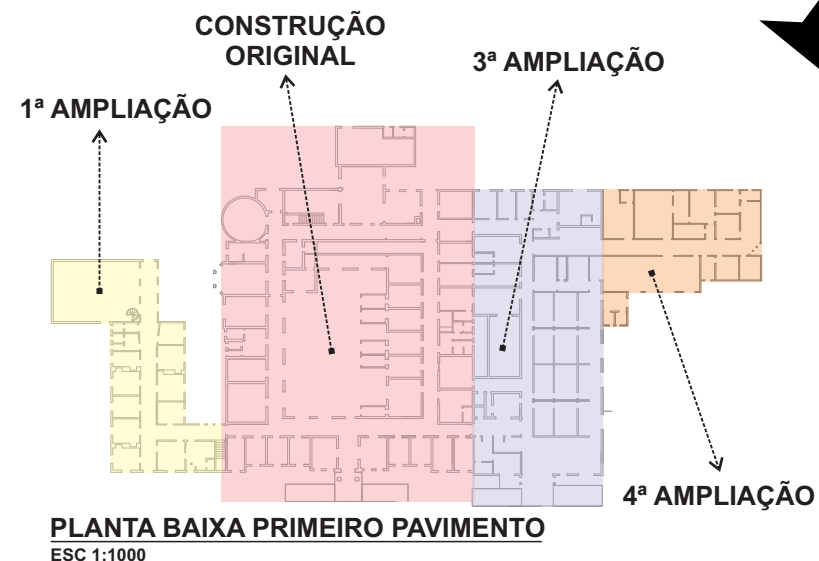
Planta Baixa do primeiro pavimento do Hospital São Sebastião. Nela, estão identificadas a área original de implantação junto com as outras três ampliações sofridas pelo hospital no pavimento inferior. Fonte: Autor.
